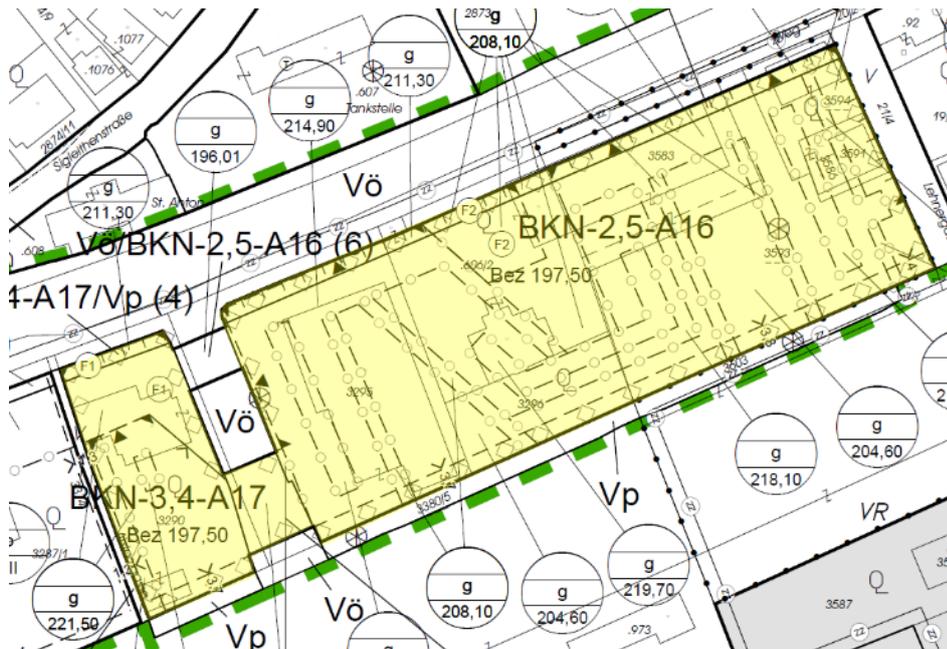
Fläche des geplanten Bezugsniveaus auf Projektfläche 1
